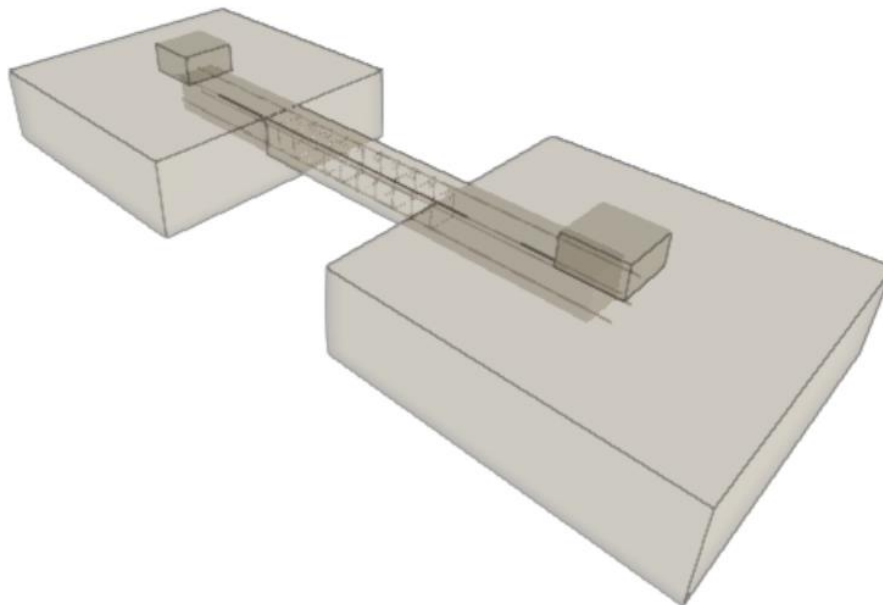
Detalle Viga de Atado (CYPE3D).
